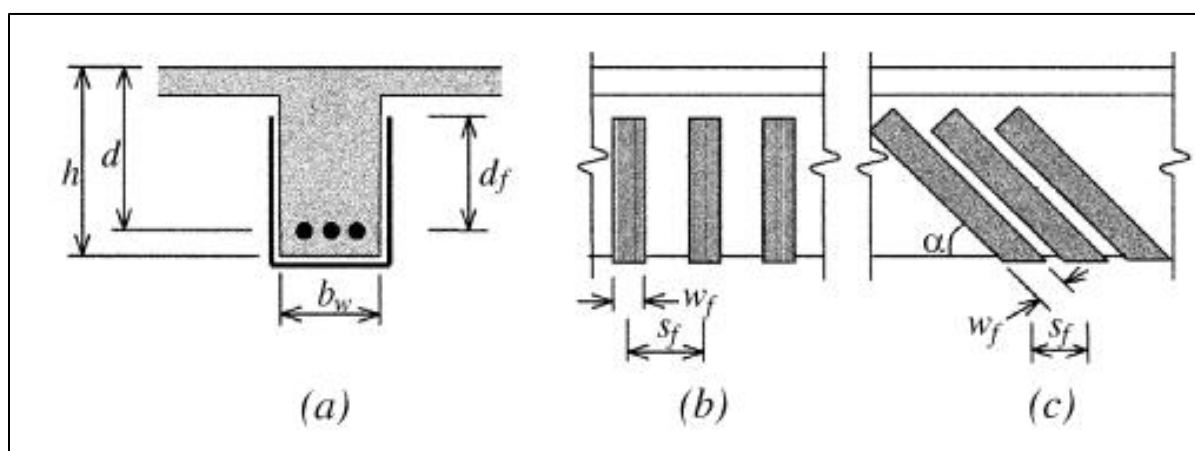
Reforzamiento a cortante con láminas FRP - Fuente: ACI 440.2R-08
